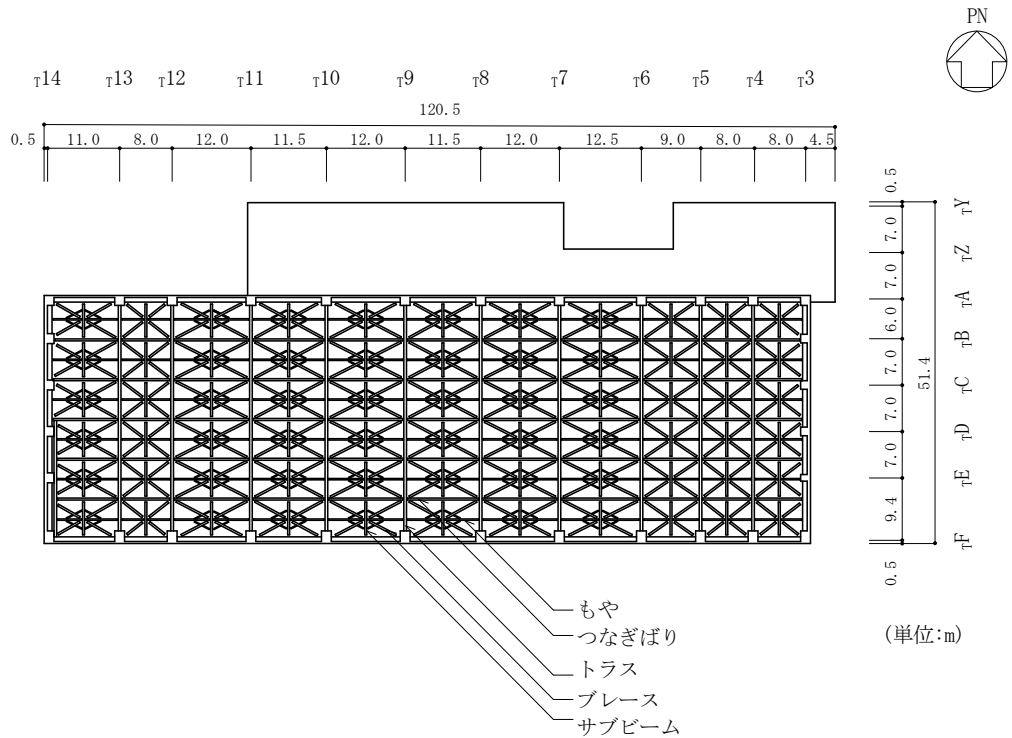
(2) タービン建物の概略平面図 (EL 41.6m)
